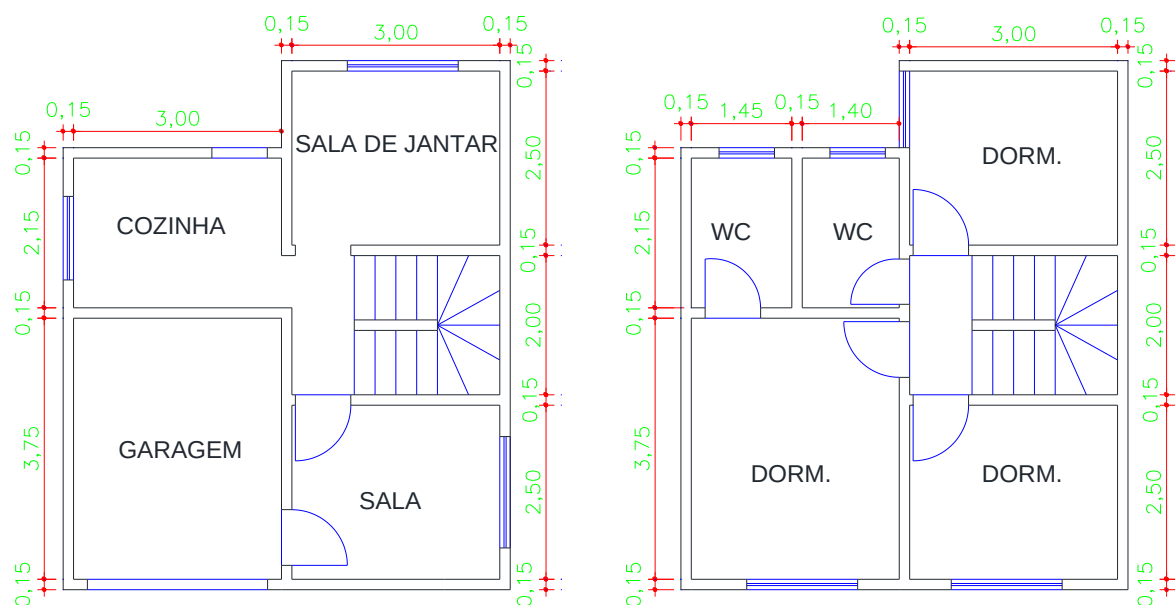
Planta baixa do sobrado unifamiliar (Sem escala). Fonte: autores.
